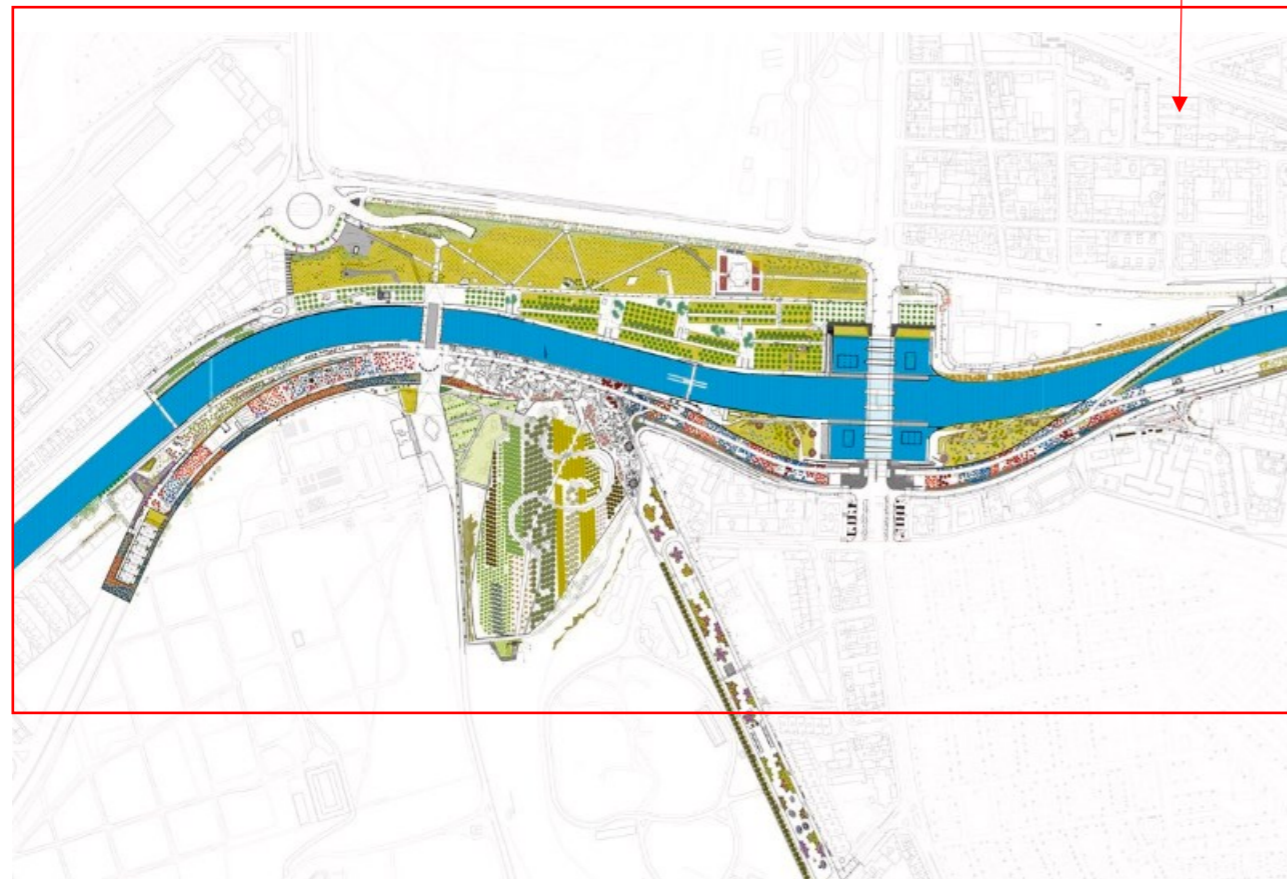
Huerta de partida, pormenor do Plano Madrid Rio
